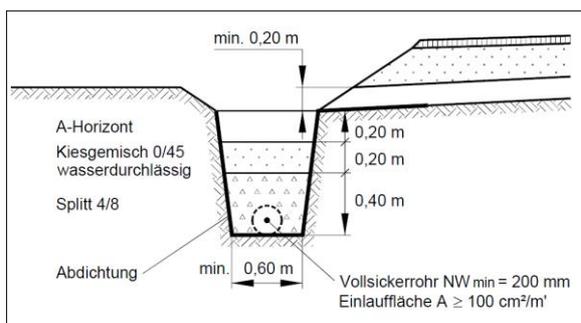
Typ 2b - Bahngraben mit bewachsener Oberfläche und Abdichtung
